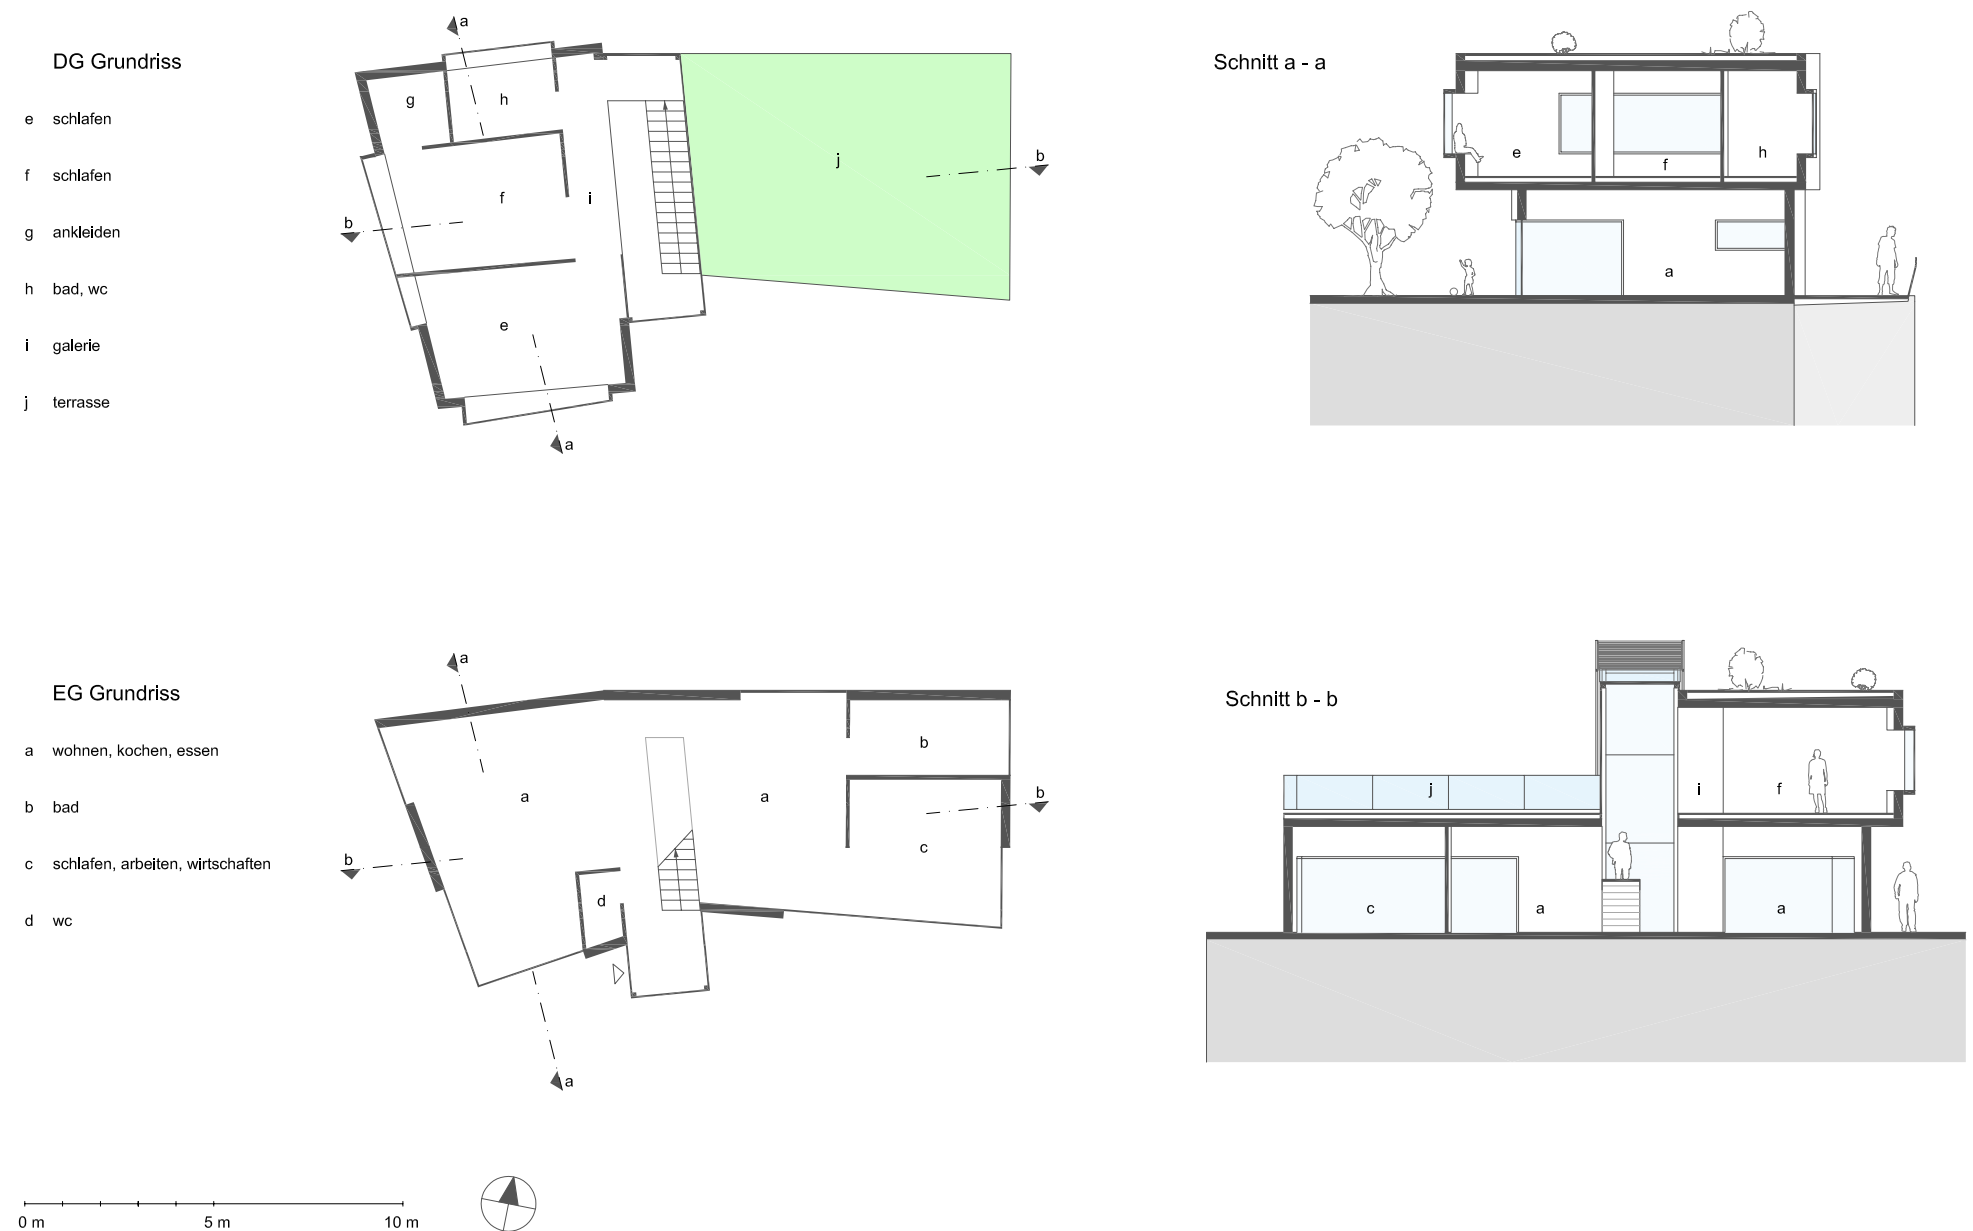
Großer Grundtyp - Grundrisse und Schnitte, 149 m<sup>2</sup>
